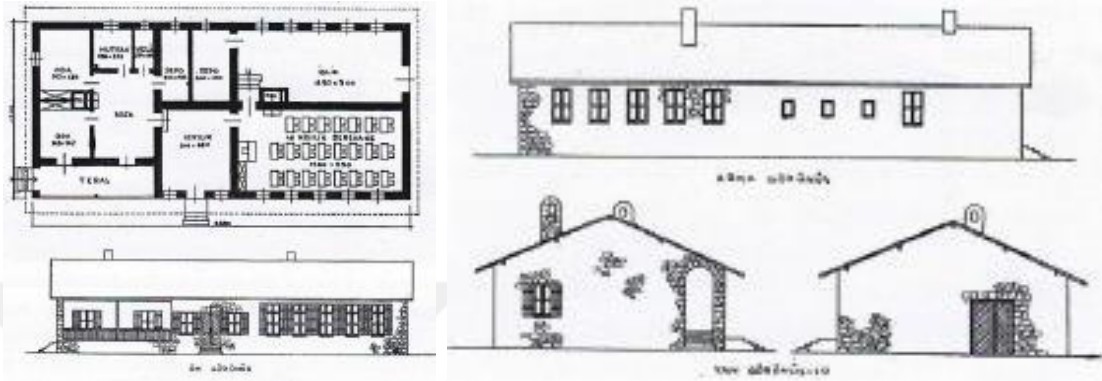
Pazarören Köy Enstitüsü ana derslik binası planı [36]
